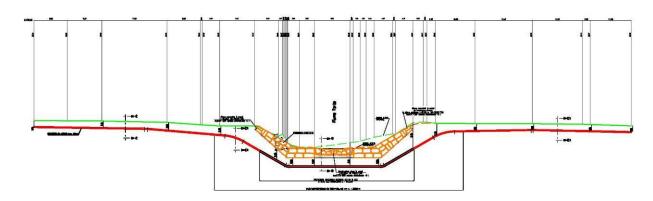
Attraversamento fiume Torto - Sezione schematica di progetto.
